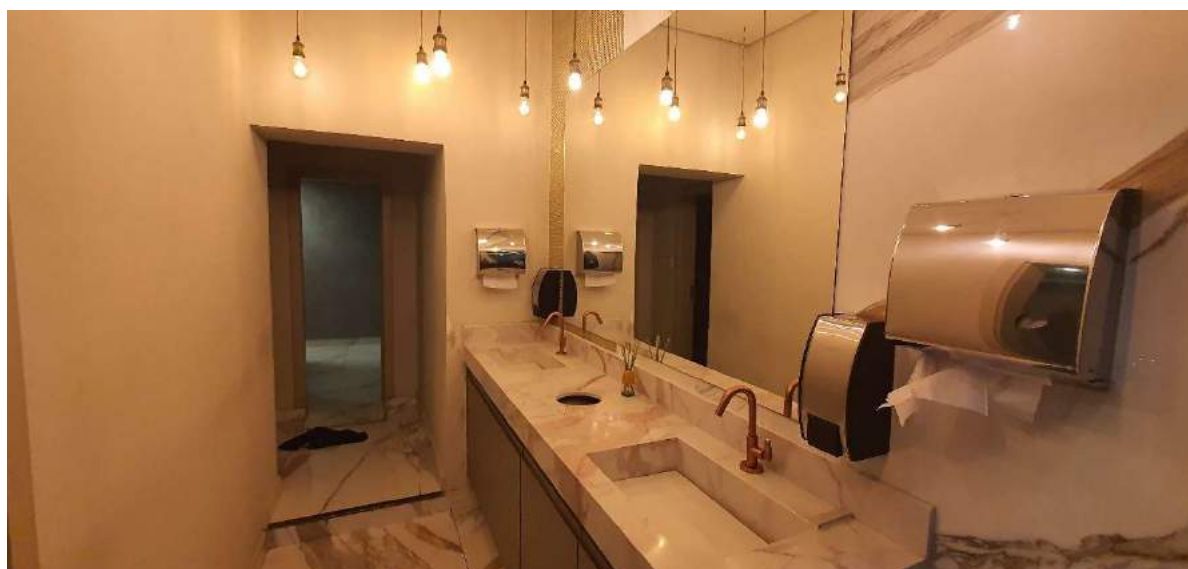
VISTA DO LAVATÓRIO, ACESSO AOS BANHEIROS.
